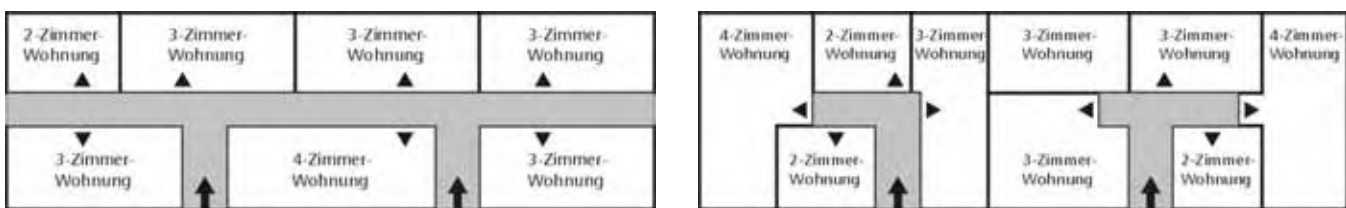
Grundriss-Varianten für den Umbau von Mannschaftsunterkünften zu Wohnungen. Quelle: Gerl (1999), eigene Darstellung.
